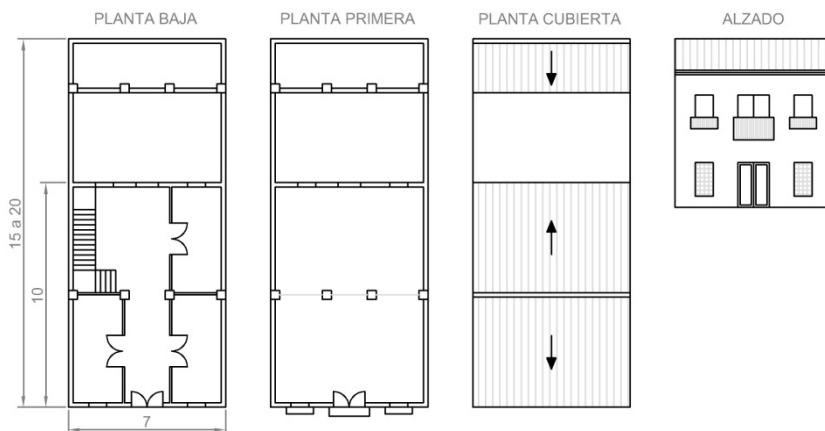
Vivienda tradicional adosada de dos plantas. Elaboración propia.
